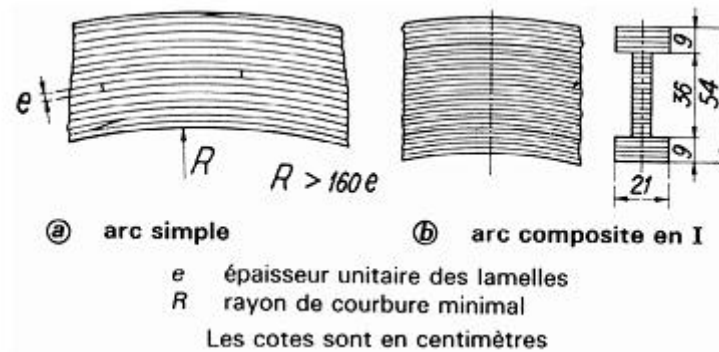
Arc lamellé (fabrication par encollage sur cintre)
